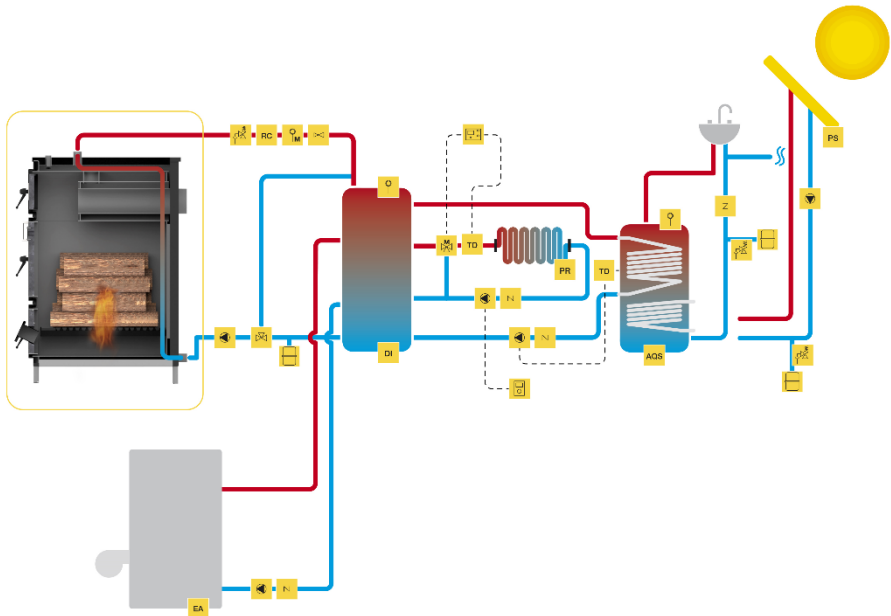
Esquema de instalação para aquecimento central e aquecimento de águas domésticas com acumulador
